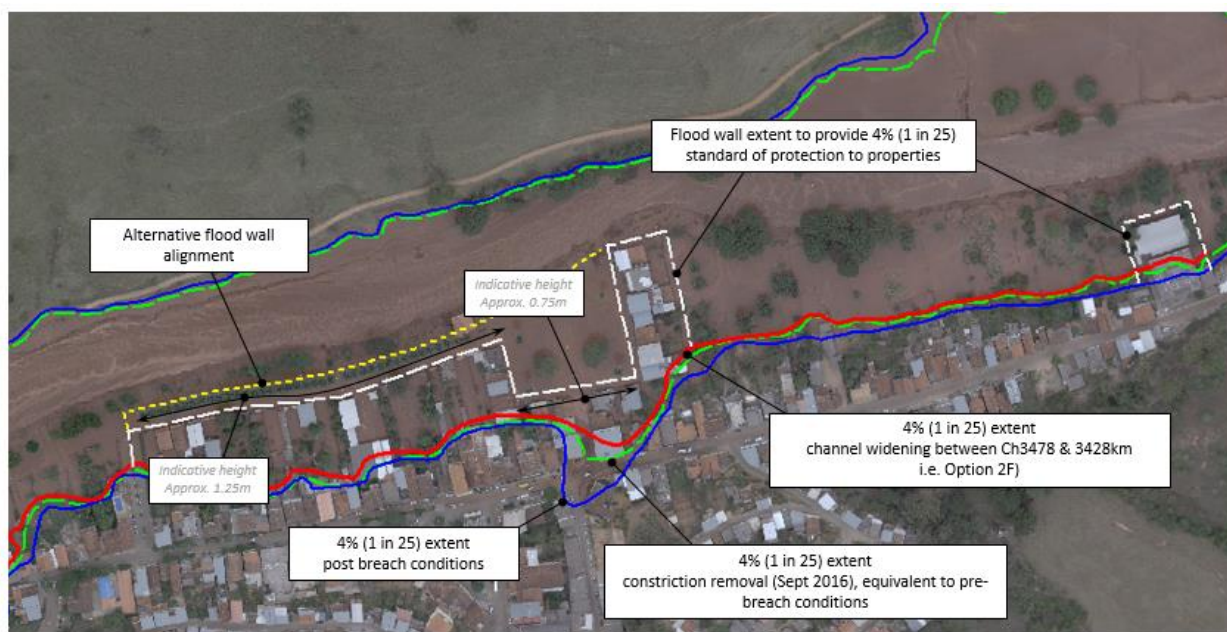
Alinhamento proposto para o muro de contenção (vista em planta).
